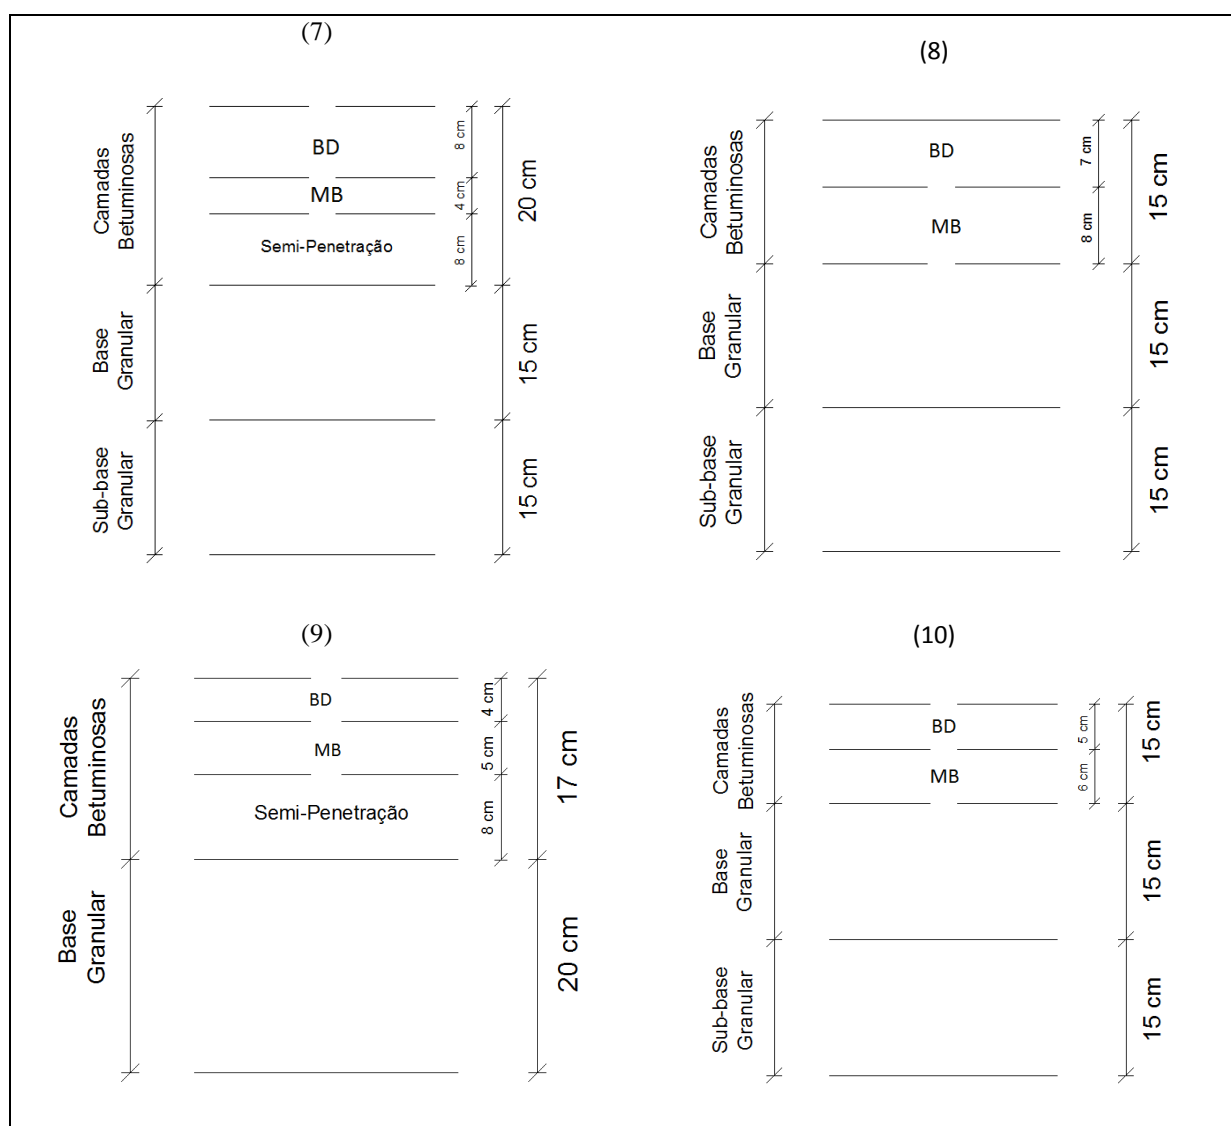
Estruturas dos pavimentos em estudo (continuação)
